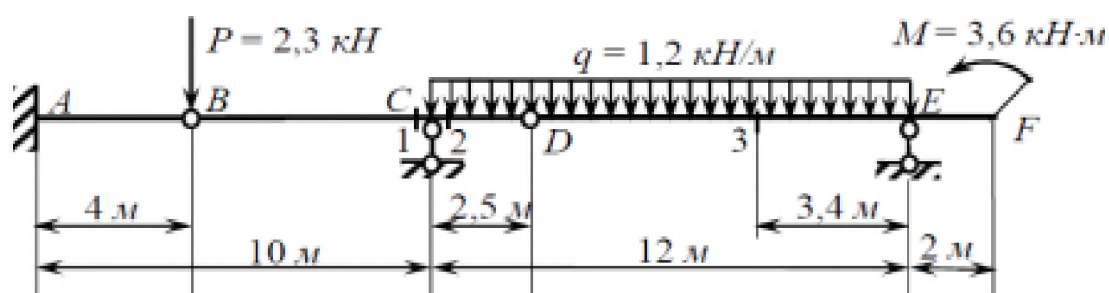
Заданная расчетная схема консольно-балочного прогона – многопролетной шарнирной балки
